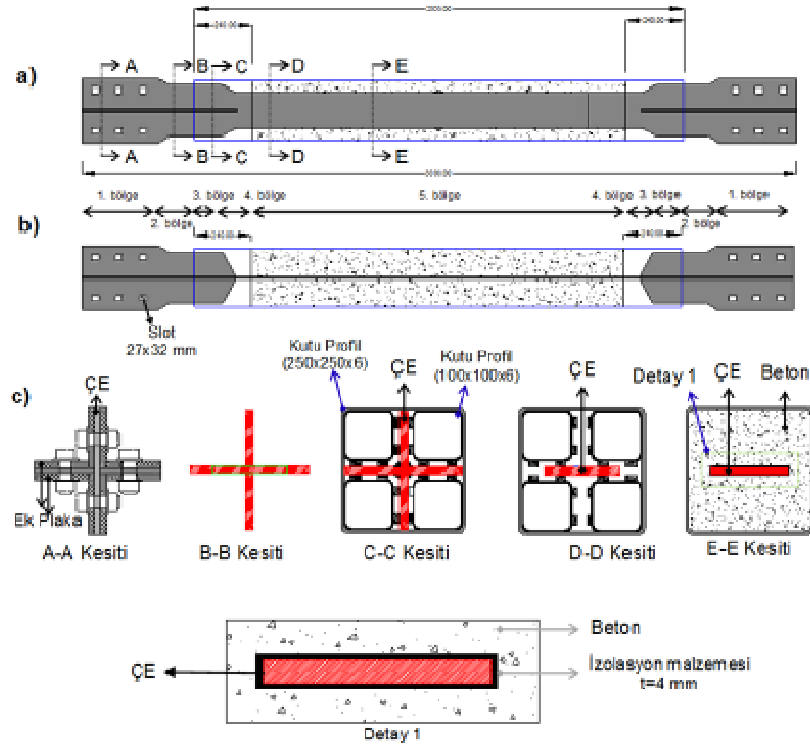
2. BEÇÇ\_1 elemanı detay çizimleri
